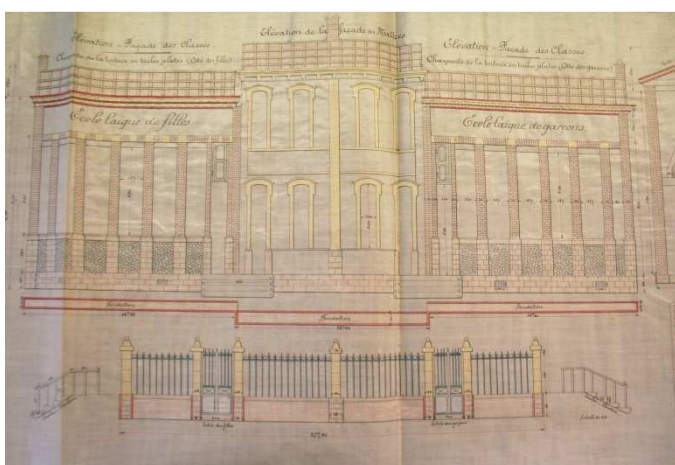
Projet de construction d'un groupe scolaire laïque.
